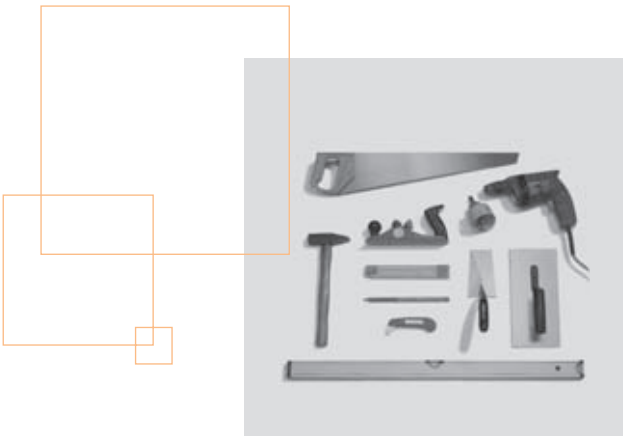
Werkzeuge zur Bearbeitung von FERMACELL Gipsfaser-Platten
